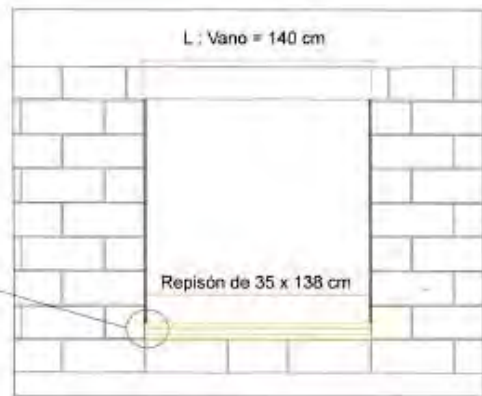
REPISÓN DE CONCRETO ARMADO EN MONOBLOQUE (de una sola pieza) imitando piezas de ladrillo evocando la construcción tradicional.
